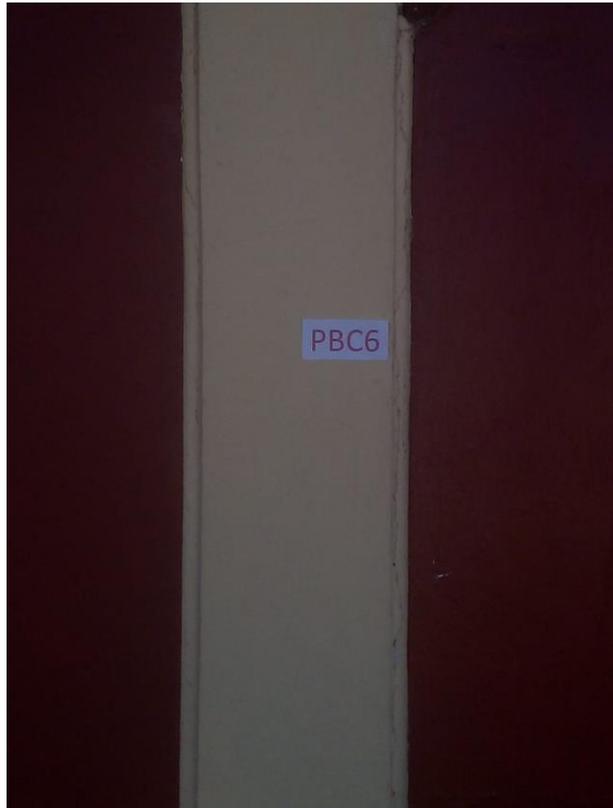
Fisuras en columna lado izquierdo y derecho en el pabellón "B"
